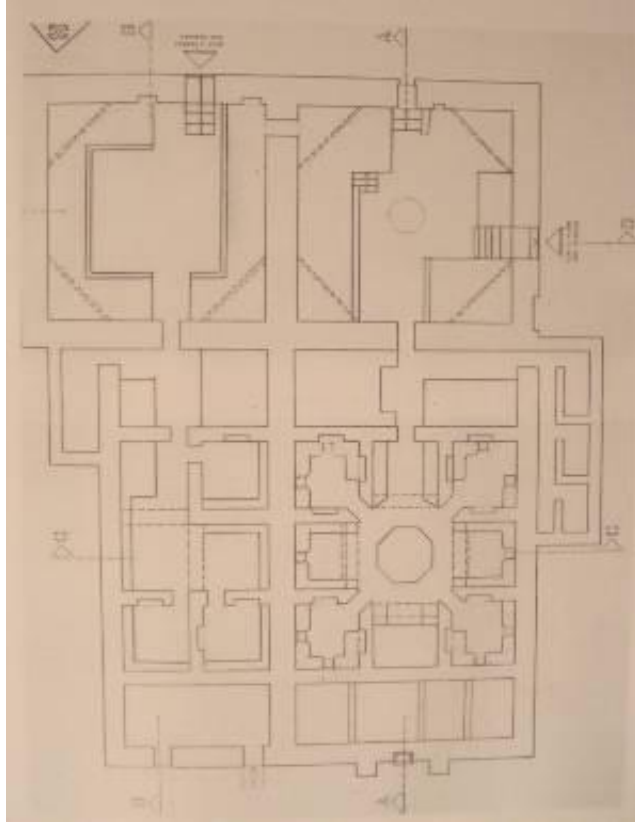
Şemsuddin Ahmet Bey Hamamı plan şeması (Raif Vırmica'dan)
